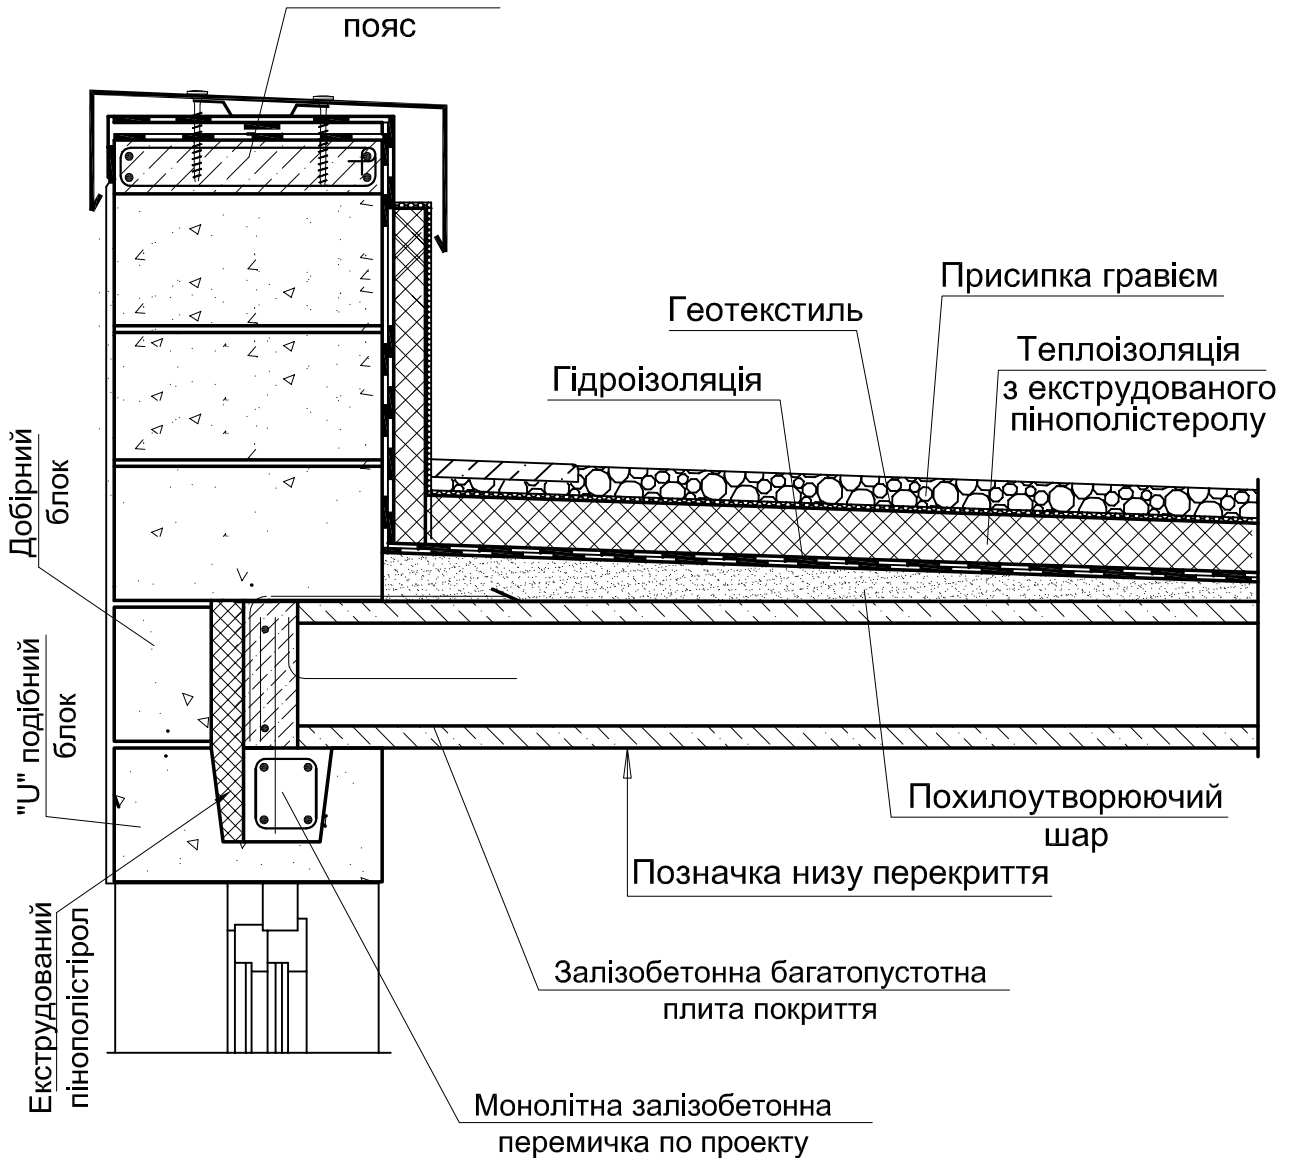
Конструювання утепленого плоского даху над збірним багатопорожнистим перекриттям даху (варіант з високим парапетом).
